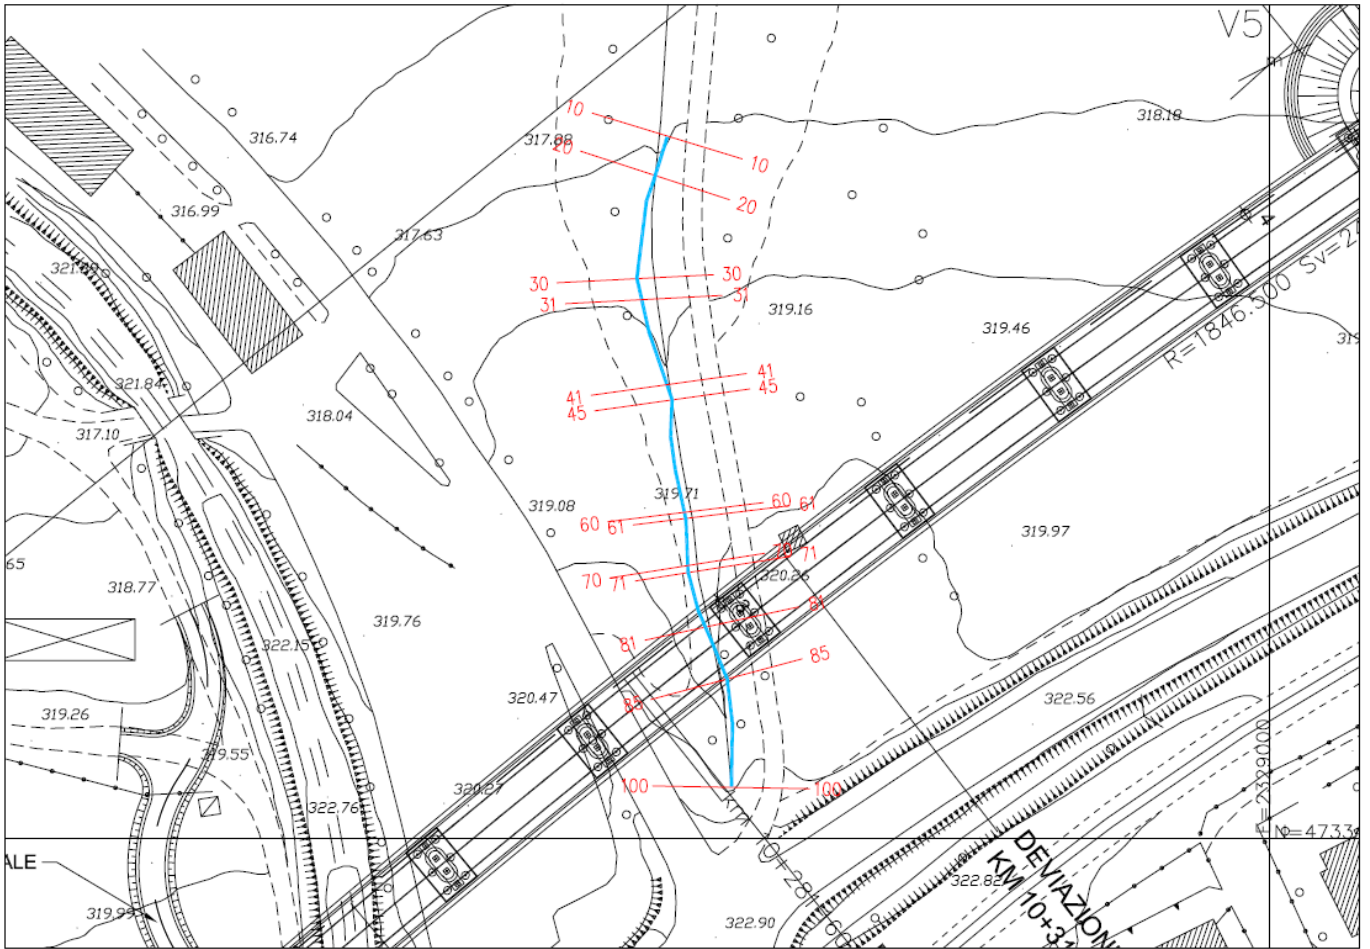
Planimetria dell'intervento e sezioni trasversali d'alveo.
